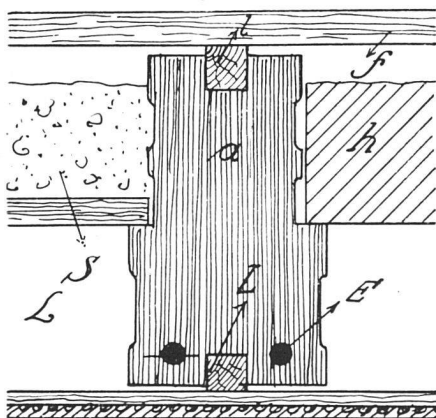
Eine Decke mit Balken und Holzfussboden.
